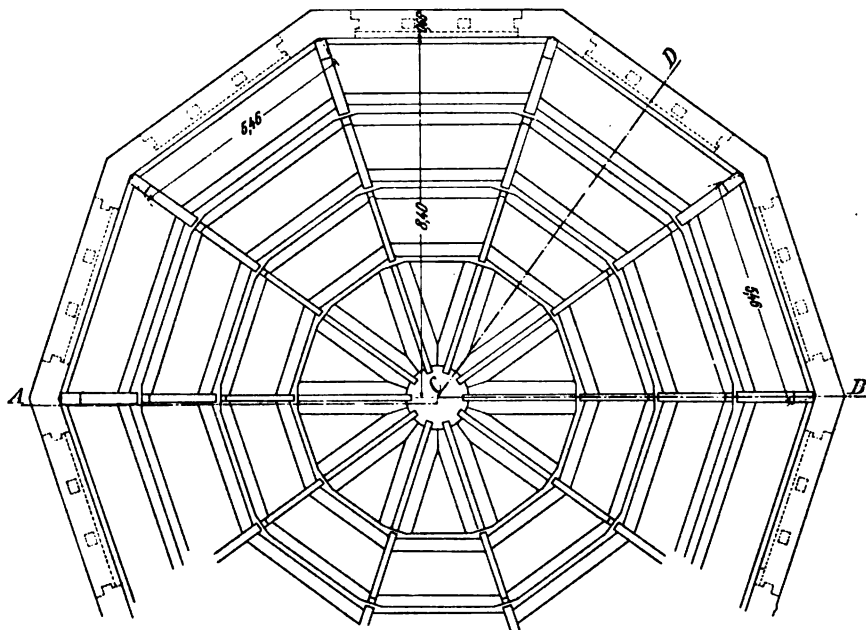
Landesgefängnis Mannheim. Grundriß.
